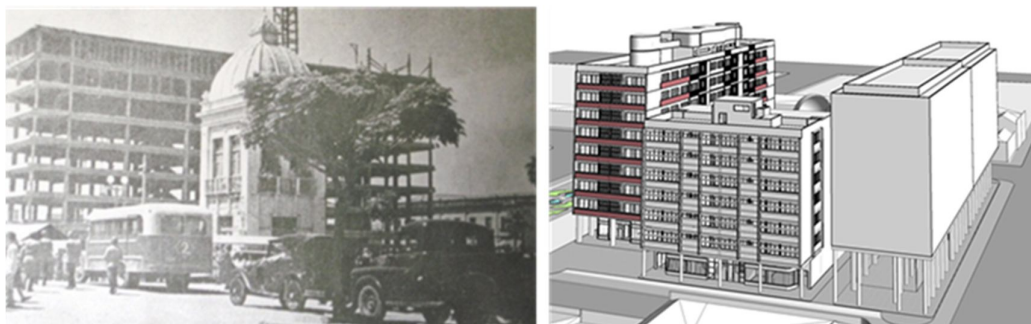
Vista do conjunto em construção (E) e projeto de Holanda Mendonça de 1955/56 (D)
